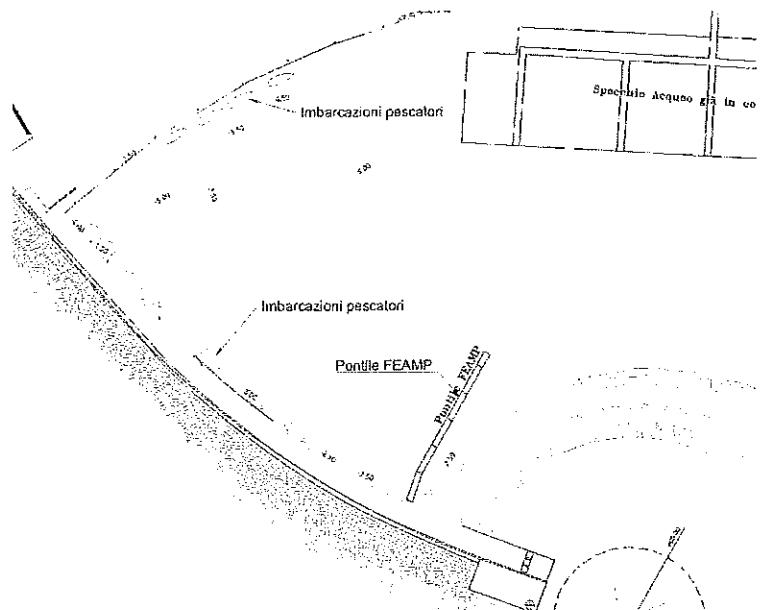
Planimetria stato di fatto - Collocazione attuale pontile FEAMP e barche pescatori
